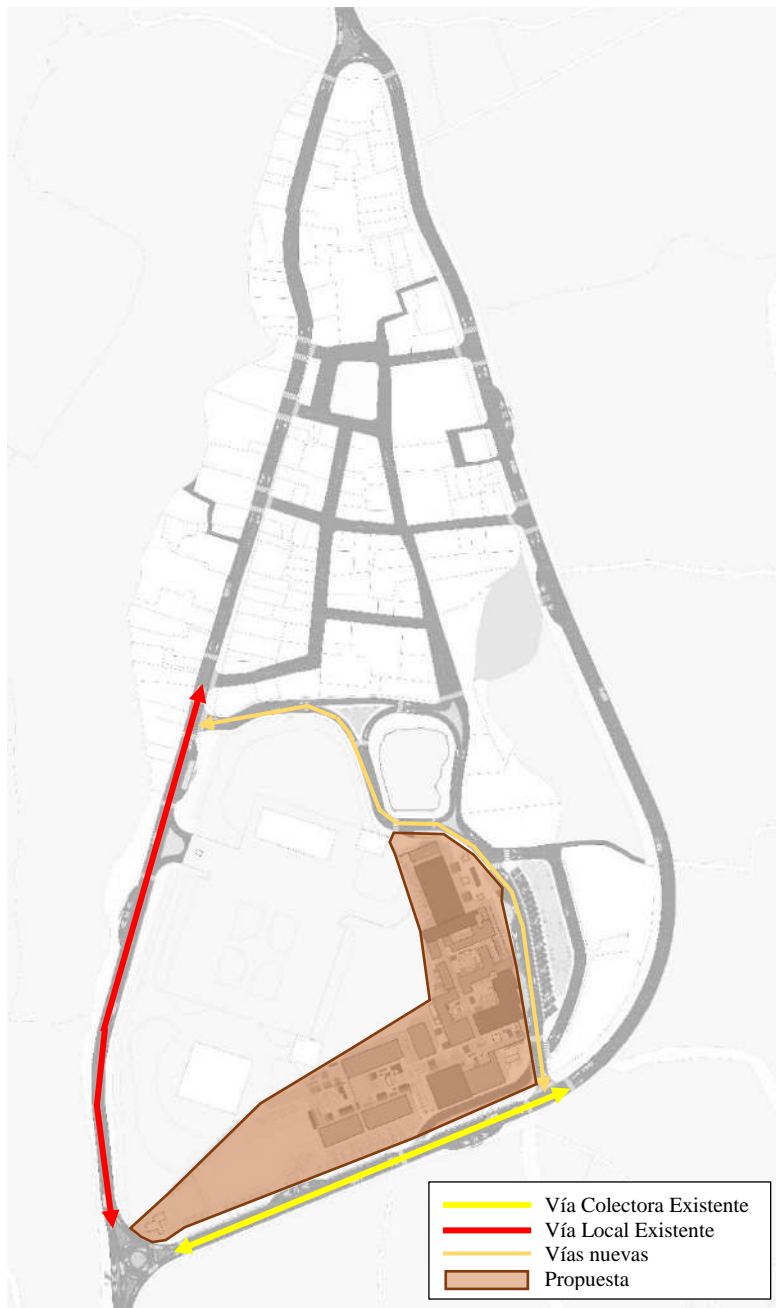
Master Plan – Propuesta Arquitectónica. Fuente: Elaboración Propia.
